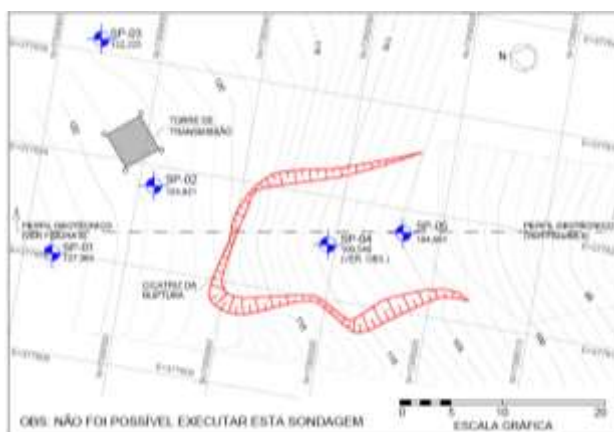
Planta de localização das sondagens a percussão (SPT) sobre levantamento planialtimétrico
